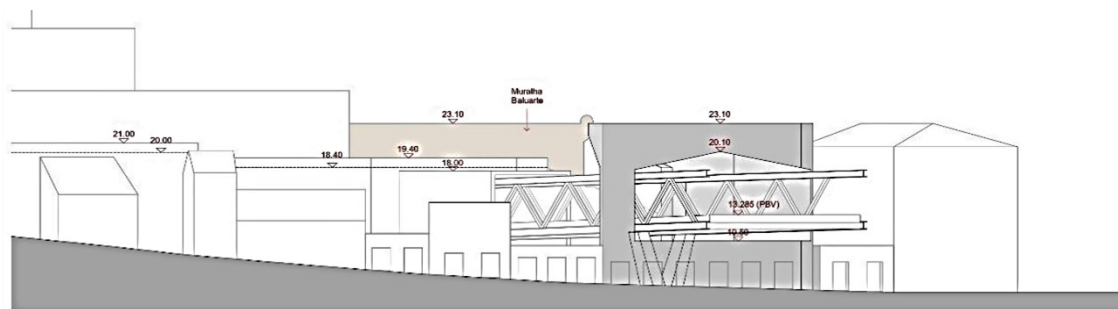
Alçado edifício e fachadas a reconstruir
